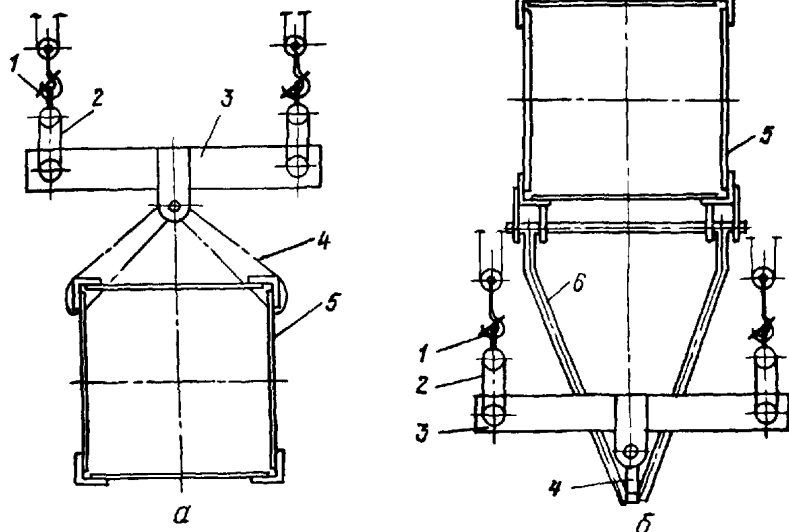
Схемы строповки конструкций с уравнивающей траверсой:
